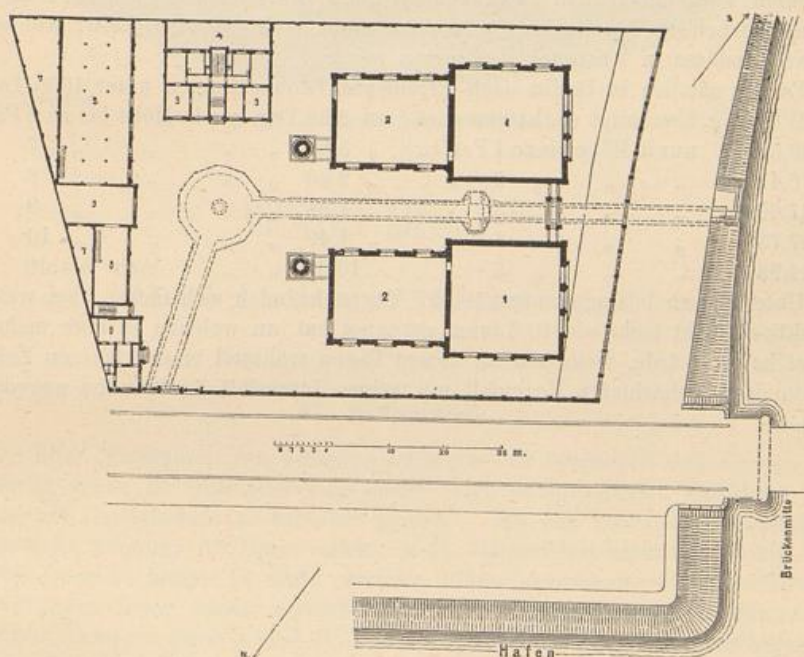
Grundriss. (Maasstab 1:1250.)
